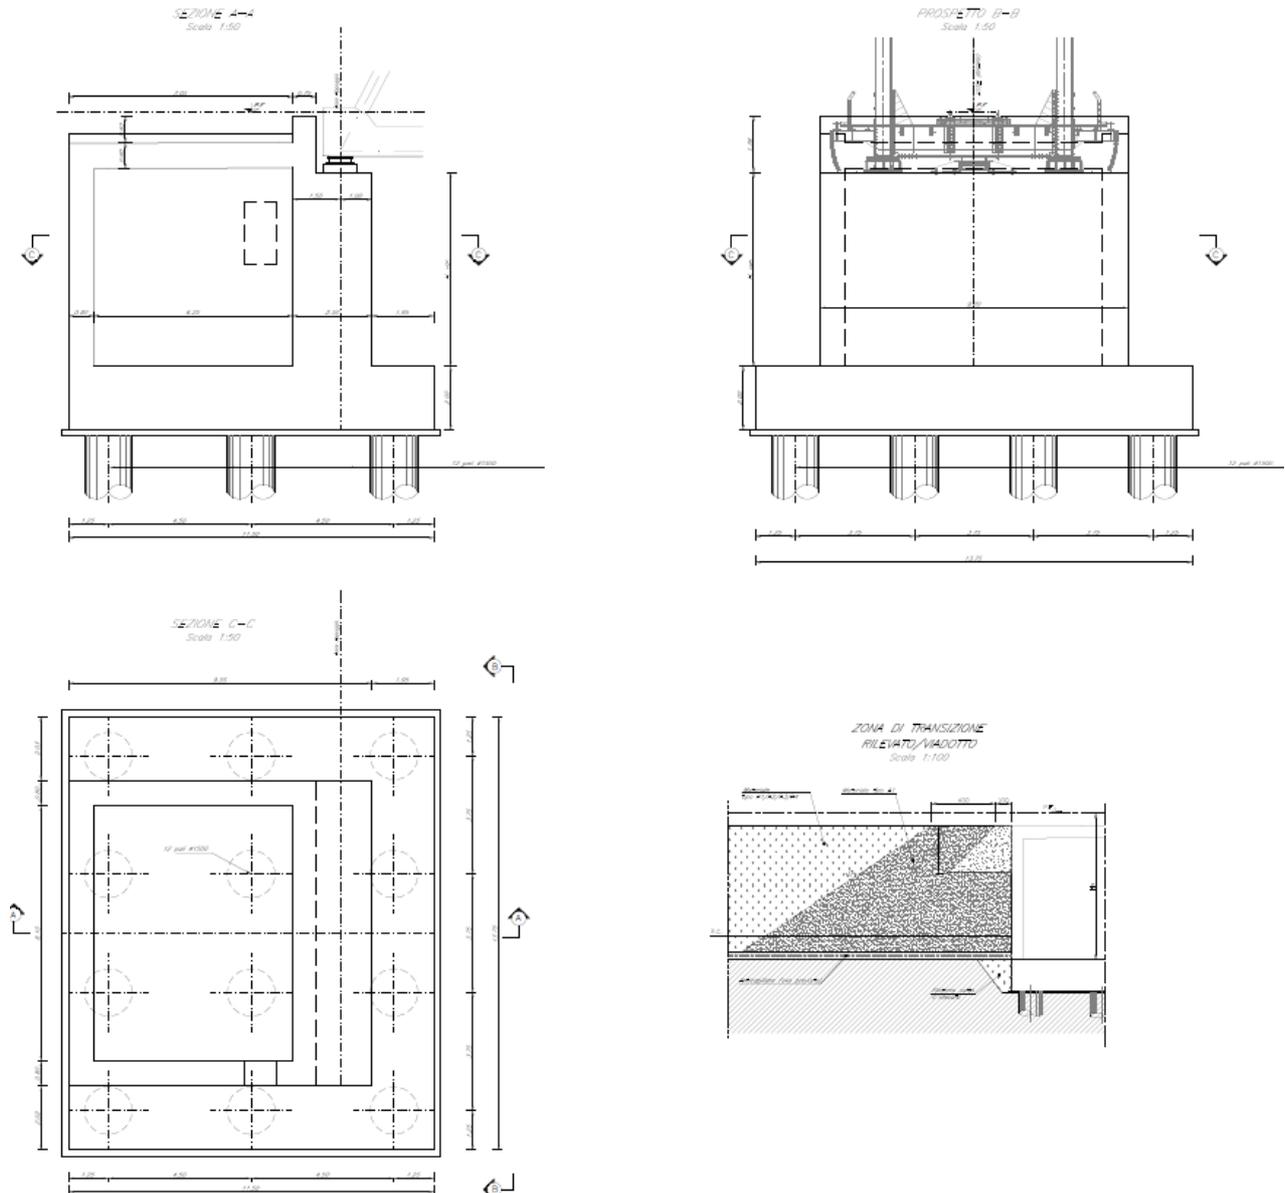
Prospetto e sezione pila campata L=69.70 m
